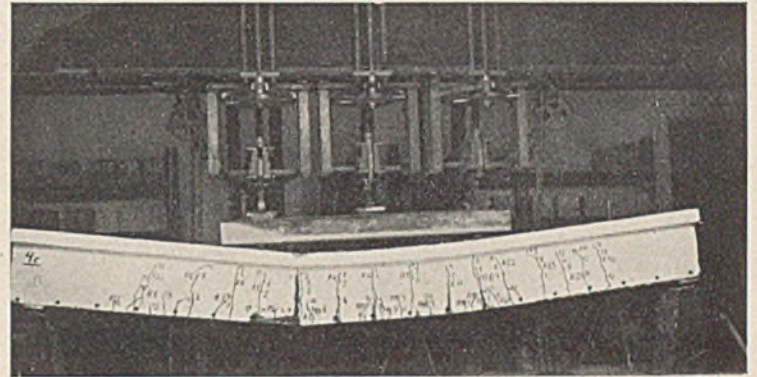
Rundstahlbalken: Biegelinie mit Knick.
